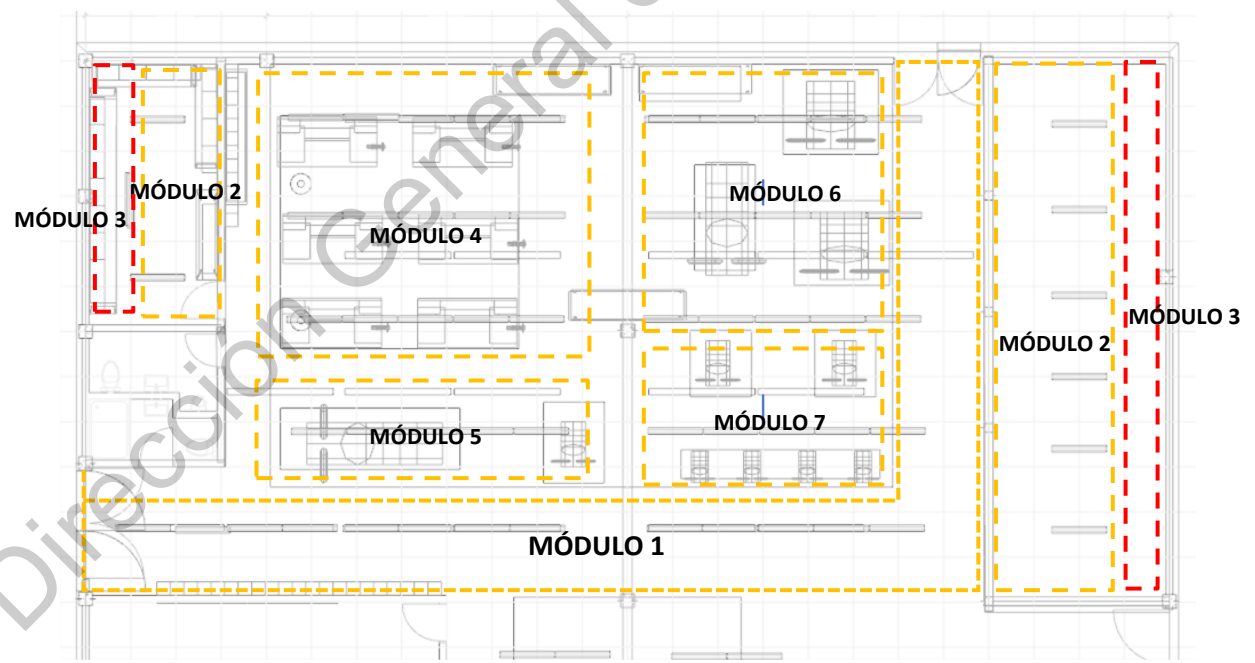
Muestra en planta de esquema por módulos de niveles de iluminación adecuado a la arquitectura.
